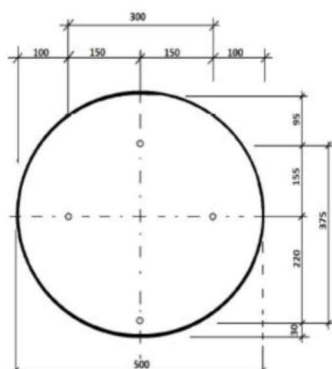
Detalhe do Dispositivo Anti-Giro e da Fundação
